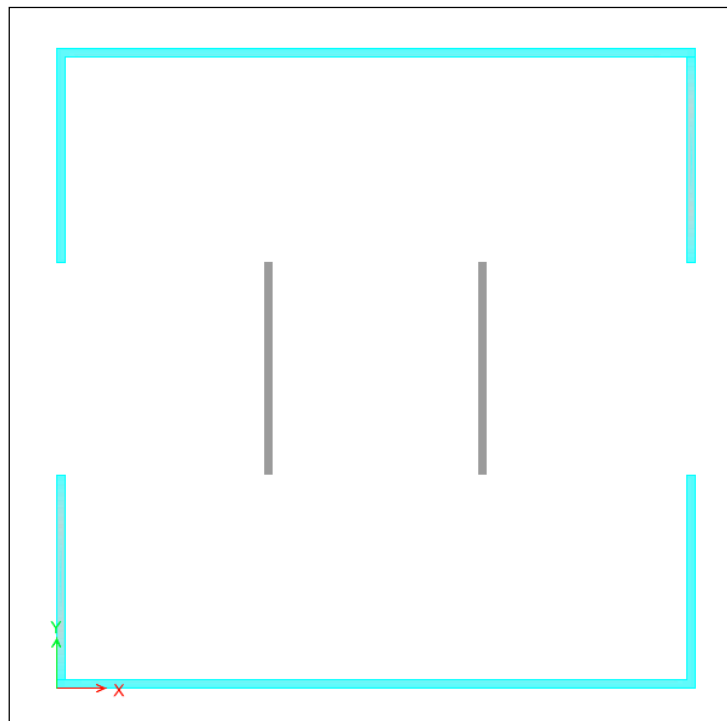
Vista en planta del Edificio E (elementos tipo barra de sección transversal irregular)
